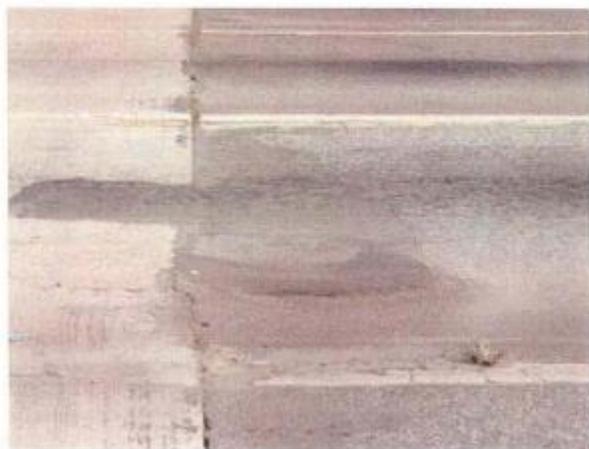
km 816 - Praça de Pedágio – transição pavimento flexível com rígido com problemas
